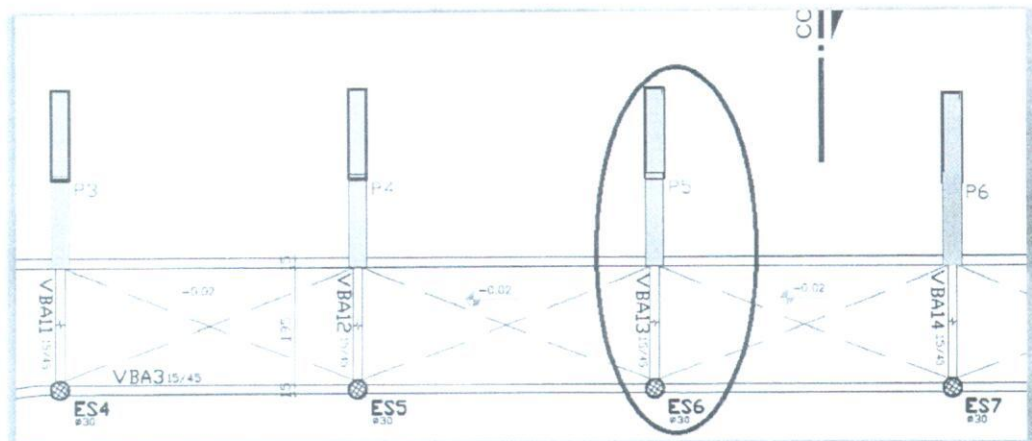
VBA 13 – PLANTA DE FORMA DO CINTAMENTO
